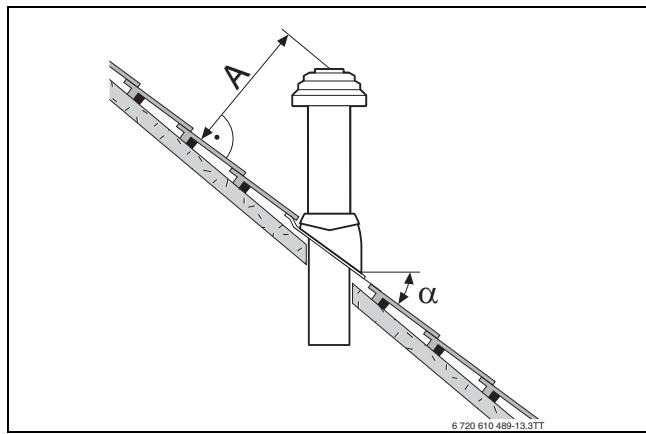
Abstandsmaße und Dachneigungen bei Schrägdach
